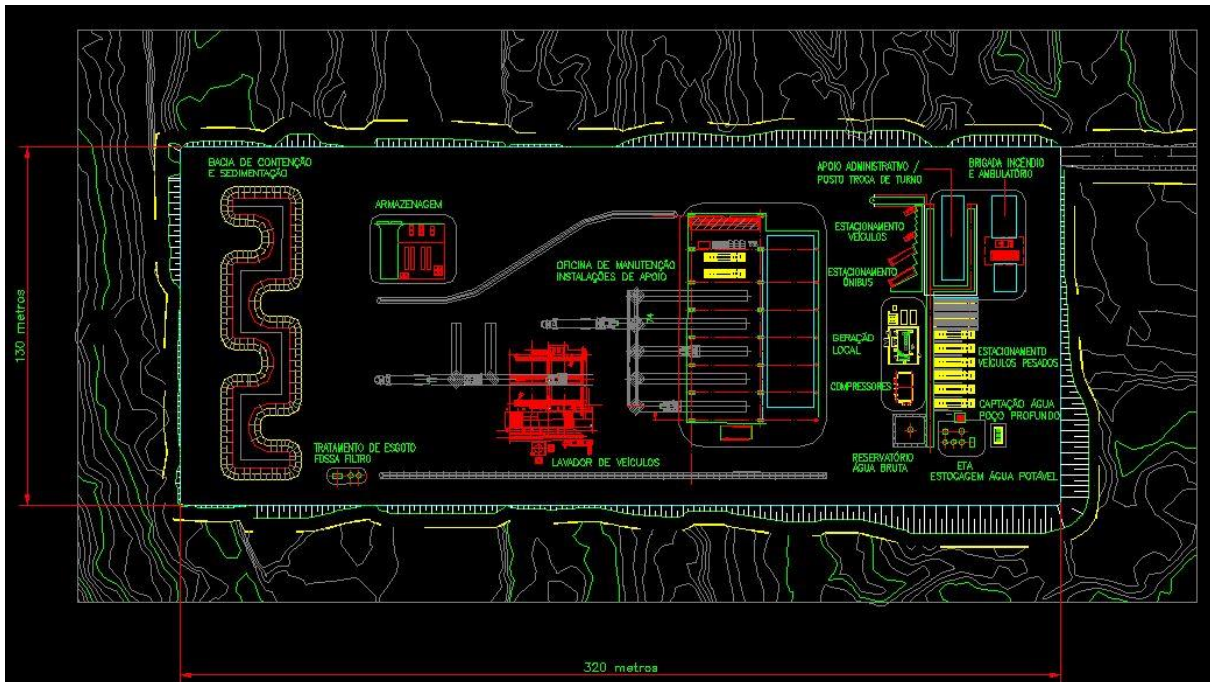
Área de Apoio a Frota de Escavação e Transporte de Rejeito
